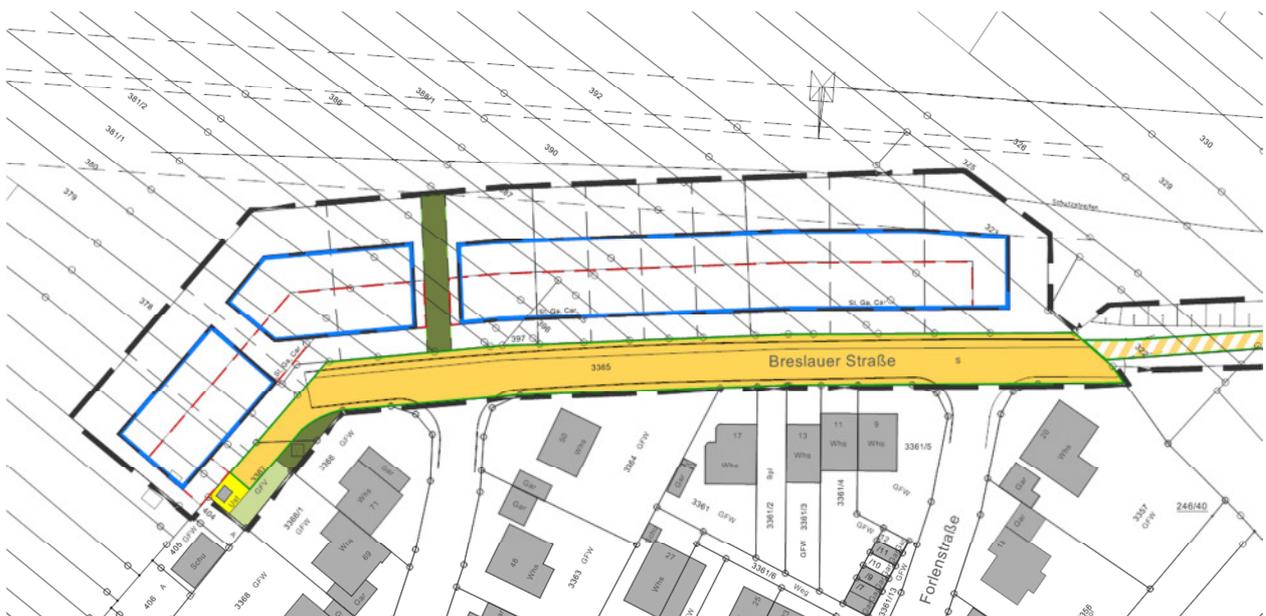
Entwurf Bebauungsplan (Planausschnitt)
